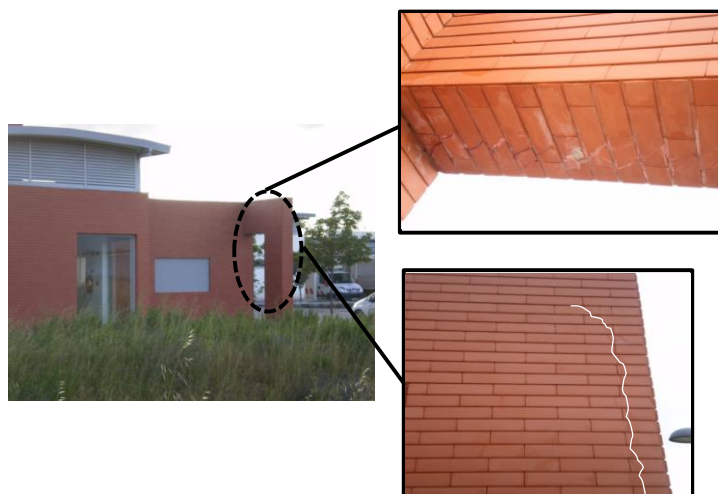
Problema de fissuração encontrado durante a visita à obra.
